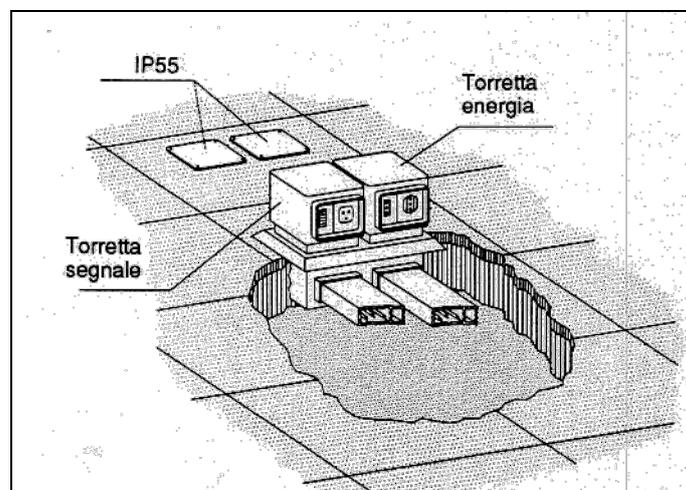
canali protettivi di sezione rettangolare incassati nel pavimento
